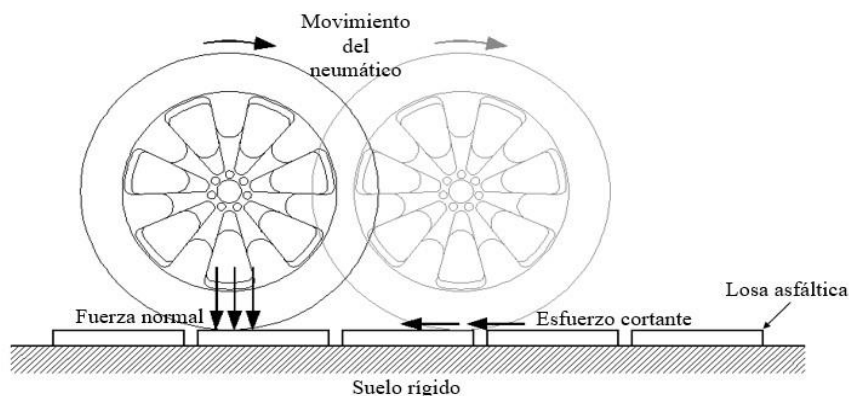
Modelo comprendido por elementos desacoplados en un pavimento asfáltico.
